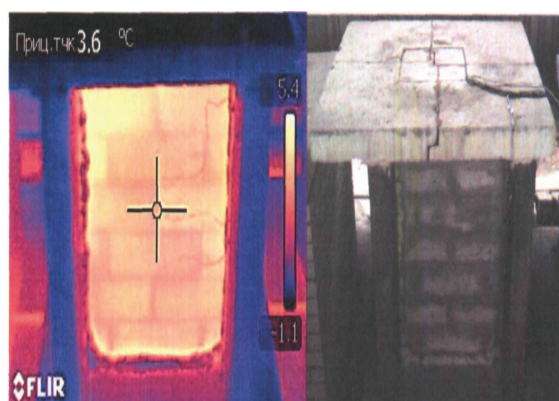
Наружная стена макета во время испытания (на термограмме)
